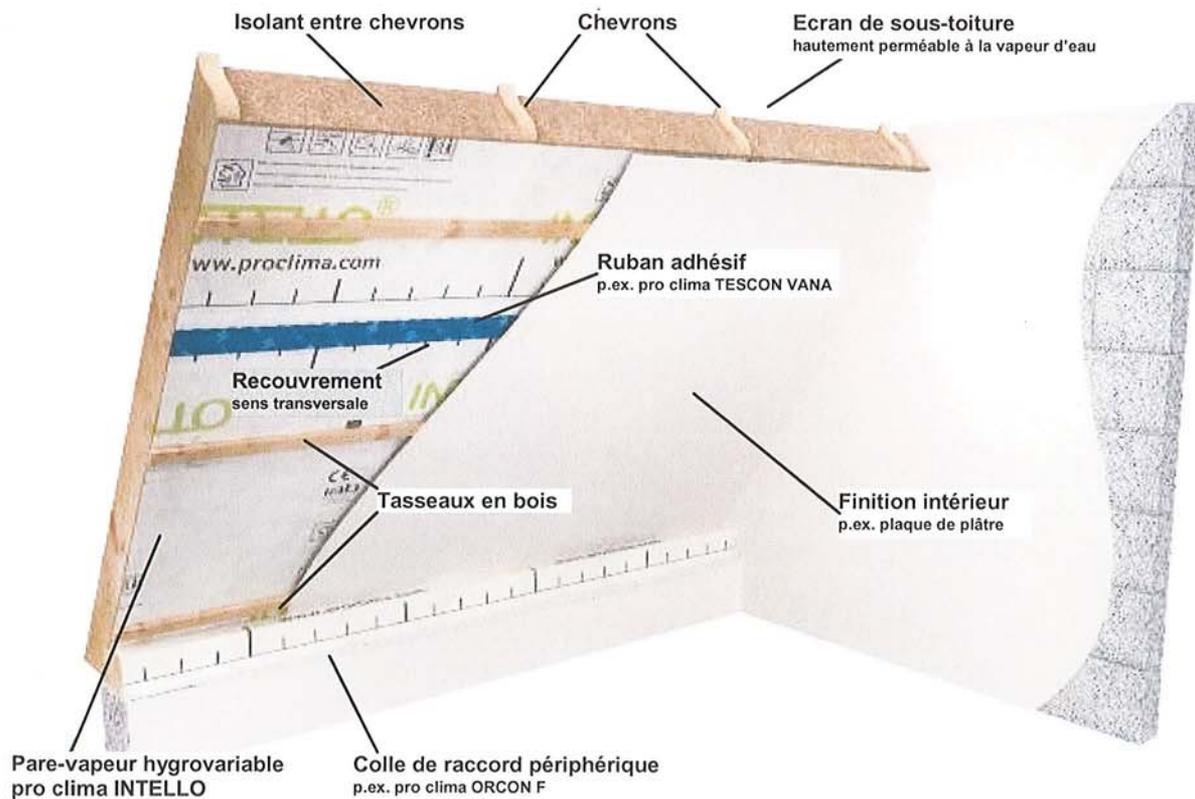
Montage du revêtement intérieur en cas de lattage d'installation
